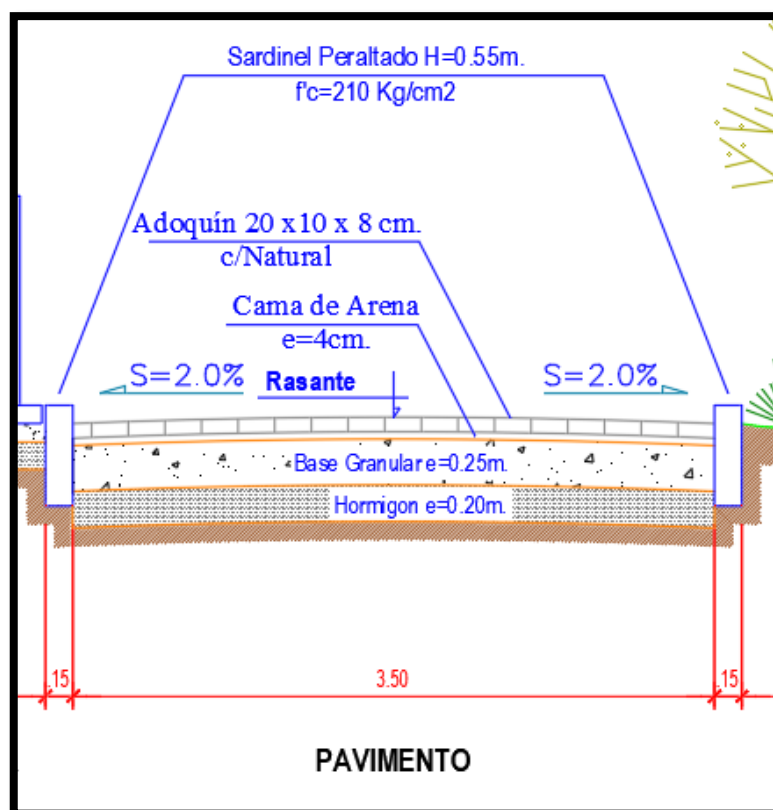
, Sección Transversal Pavimento Semiflexible.
